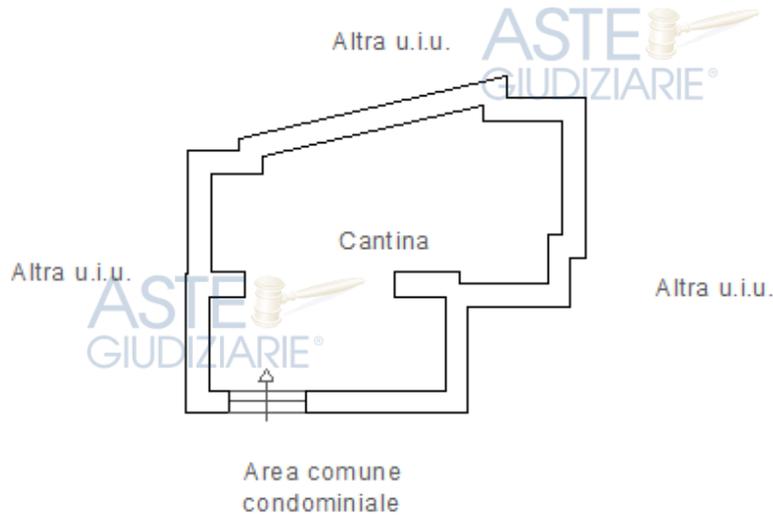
Planimetria della cantina oggetto di pignoramento (subalterno 89)
